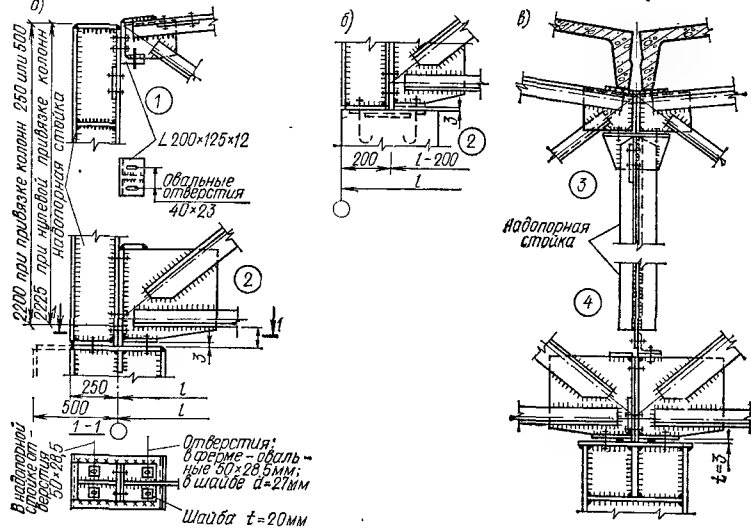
Опорные узлы (1—4) типовых унифицированных ферм с опиранием на крайнюю (а, б) и среднюю (в) колонны сверху
